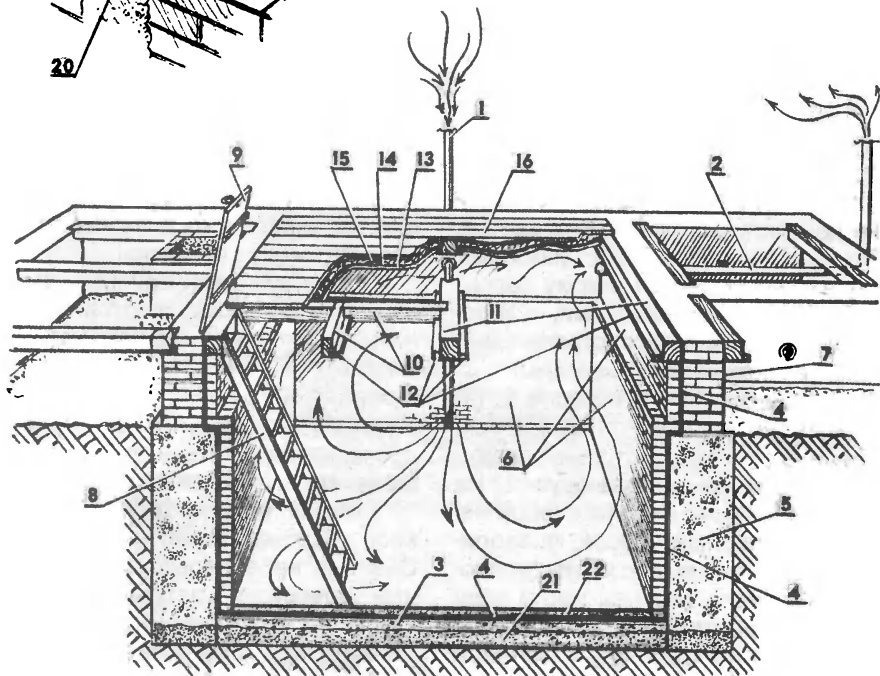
Устройство погреба: 1 — приточная труба, 2 — вытяжная труба, 3 — бетонное основание, 4 — гидроизоляция, 5 — фундамент, 6 — облицовка кирпичом, 7 — цоколь, 8 — лестница, 9 — крышка люка, 10 — каркас люка, 11 — балка перекрытия погреба, 12 — черепной брус, 13 — черный пол, 14 — рубероид, 15 — утеплитель, 16 — доски пола, 17 — отверстия, 18 — проволока, 19 — материя, смоченная в цементном растворе, 20 — заделка раствором, 21 — песчаная подушка, 22 — цементная стяжка.
